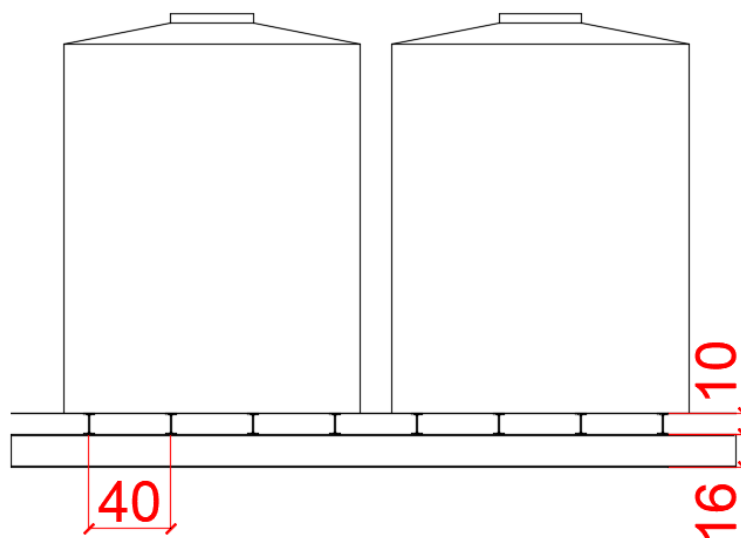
Tanques prefabricados sobre plataforma metálica
